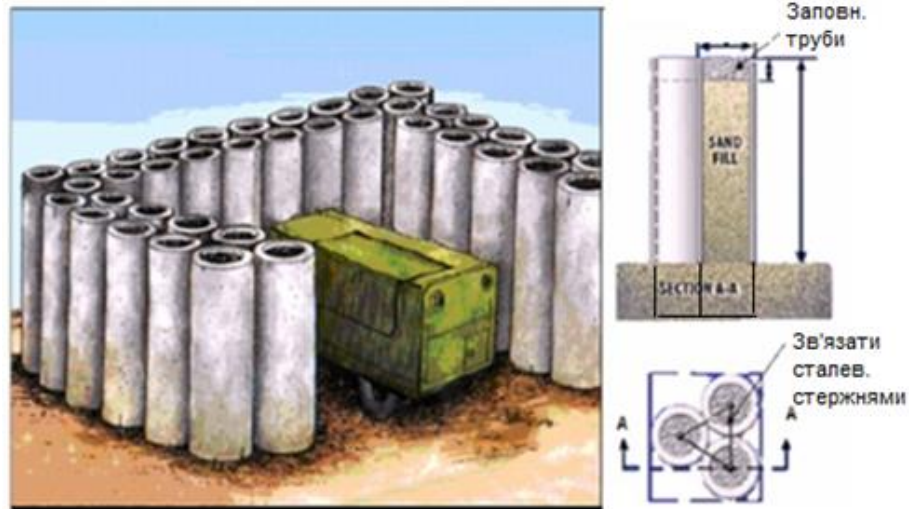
Підпірні стінки із залізобетонних труб із заповненням ґрунтом
